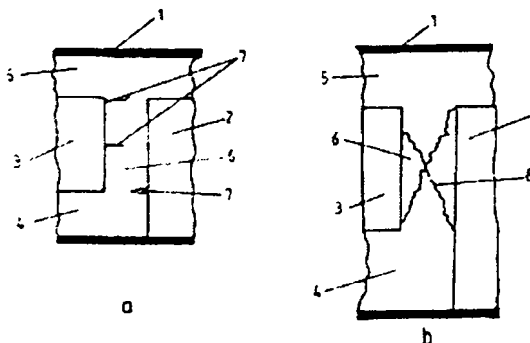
fisuri in zona spaletilor ; a) fisuri transversale ;b) fisuri inclinate ;1-planseu ;2 ;gol de usa ; 3-gol de fereastră ;4-parapet ; 5 –buiandrug ;6-spalet 7-fisuri transversale ;8-fisuri inclinate
